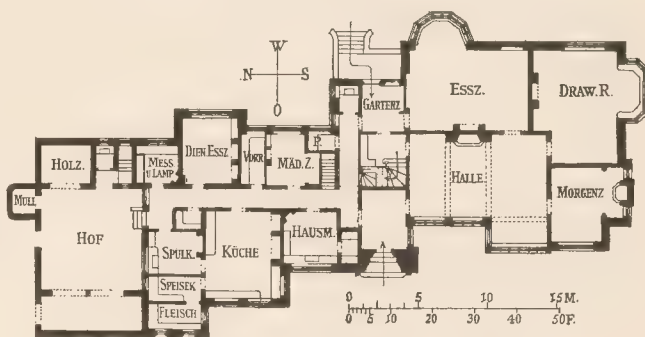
Landhaus Plas Dinam, Montgomery. Erdgeschoss. Erbaut 1872 von Eden Nesfield. 1:400.
